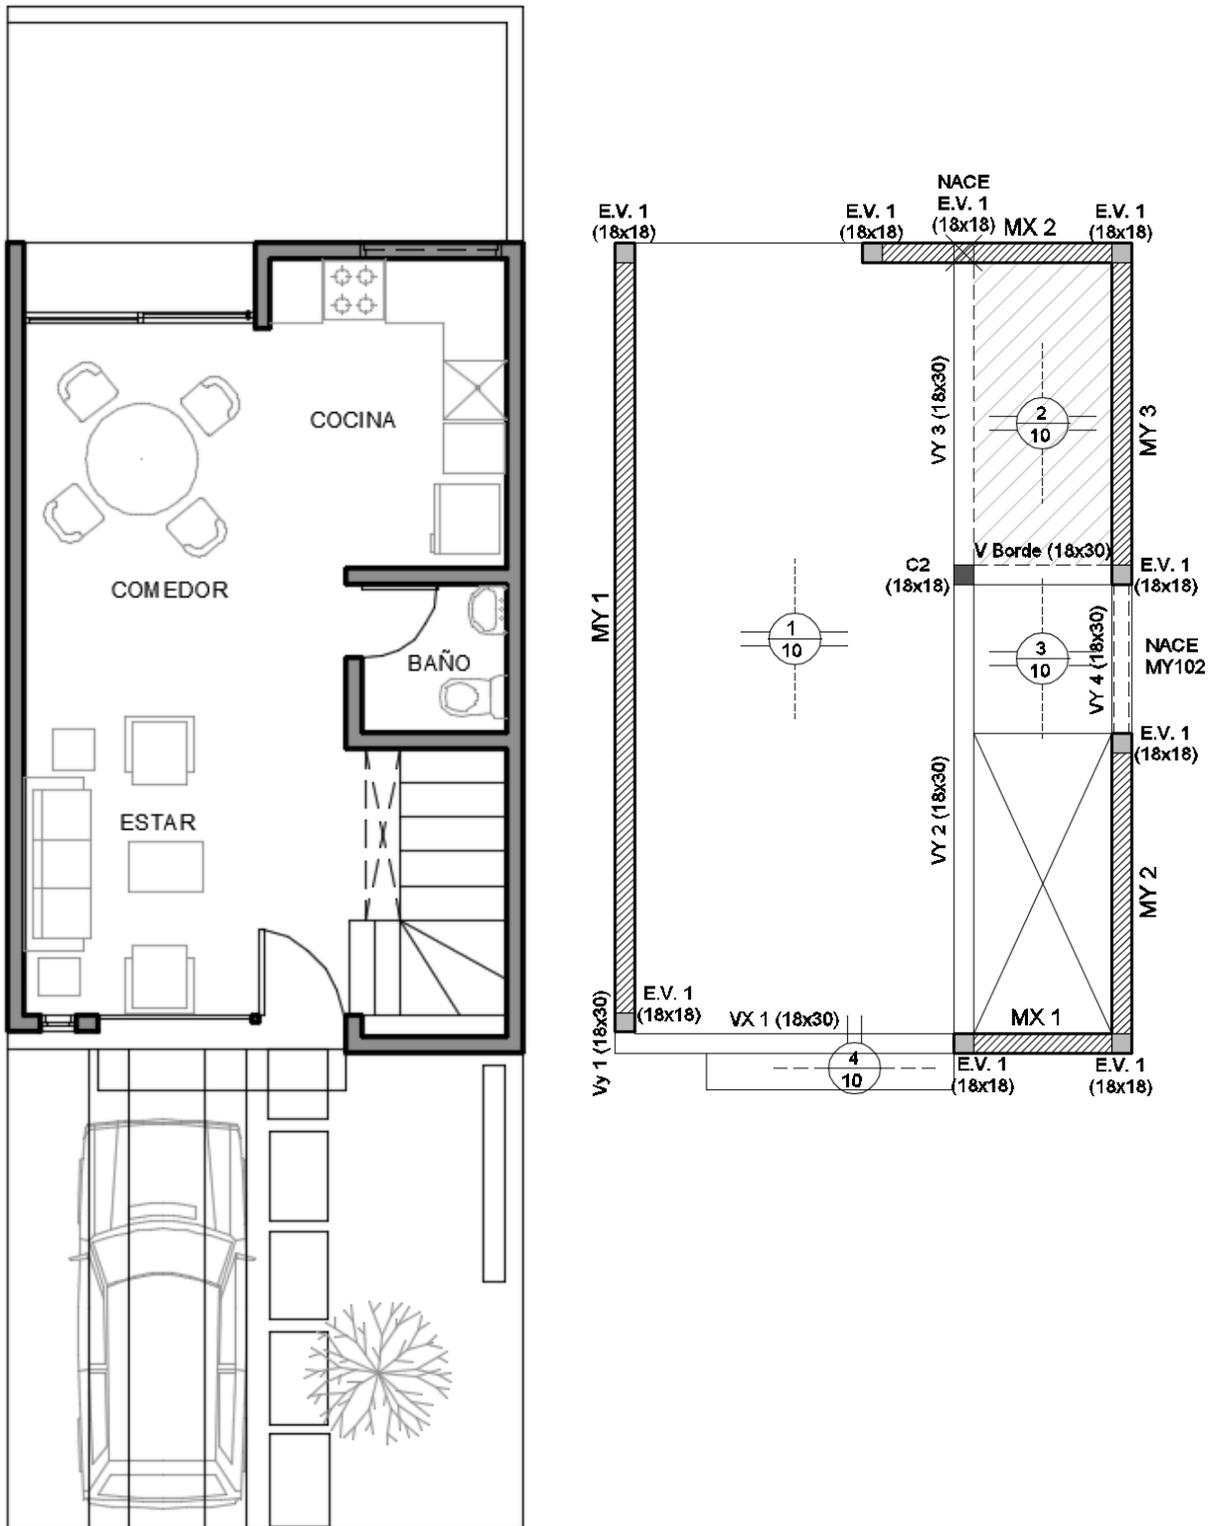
Izq.: Planta baja (Arquitectura) - Der.: Losa sobre planta baja (Estructura)
